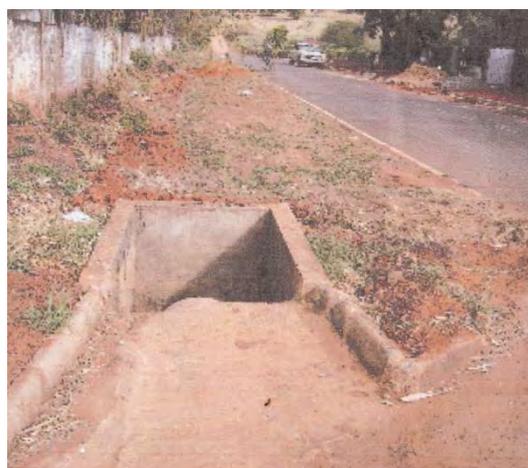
equipamento de drenagem da Rua Campos Salles.
